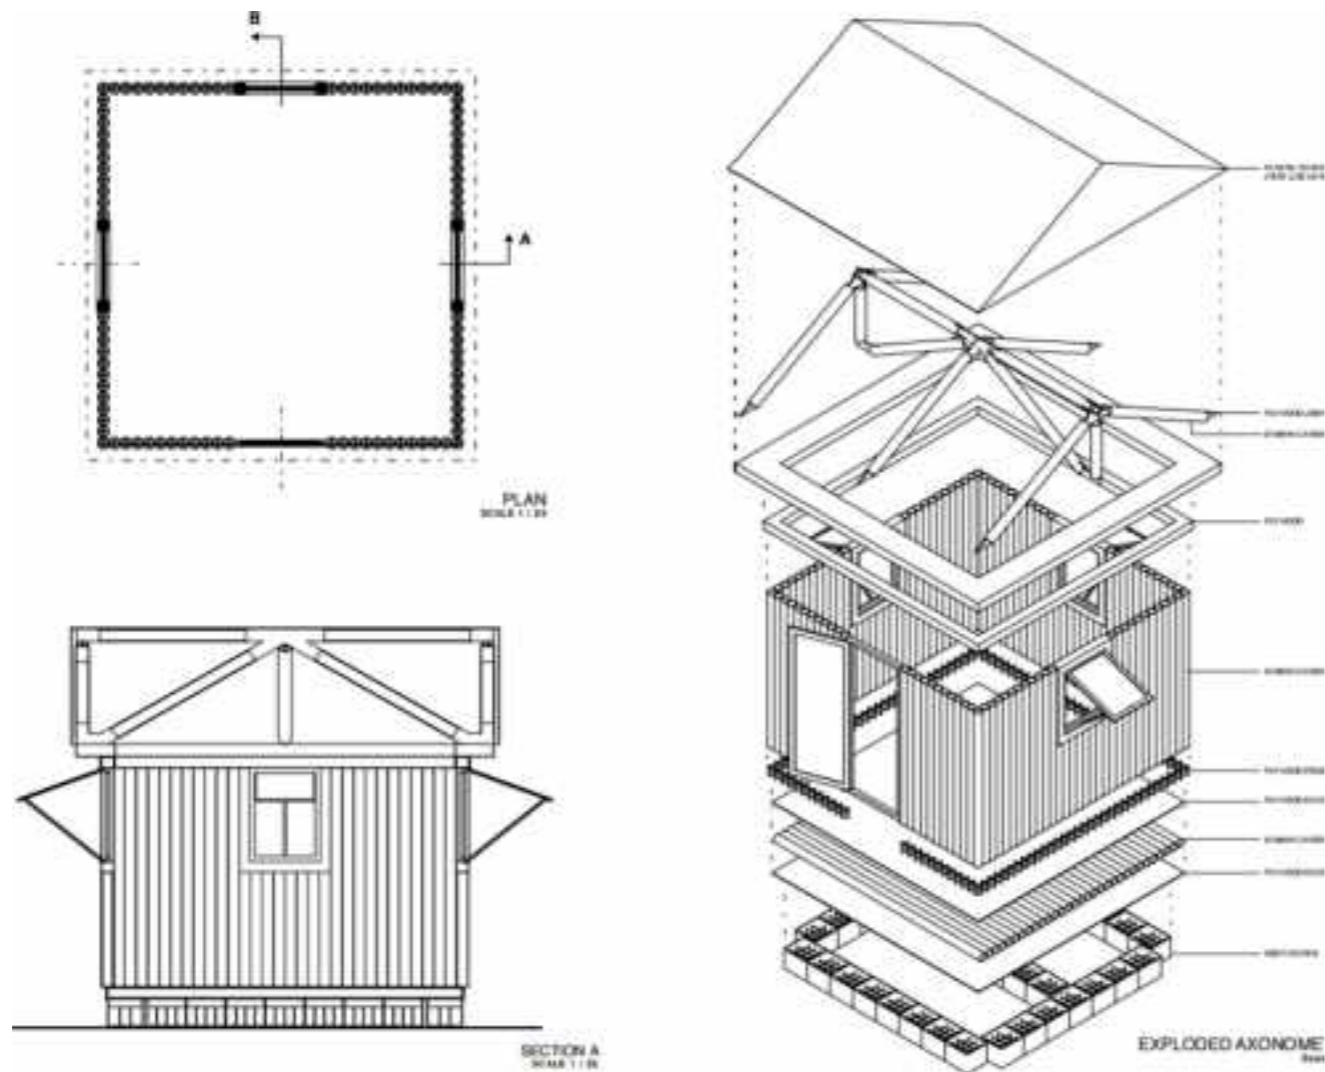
Planos de refugio Paper Log Houses – Kobe, Japón. 1995. Fuente: Designboom.com
